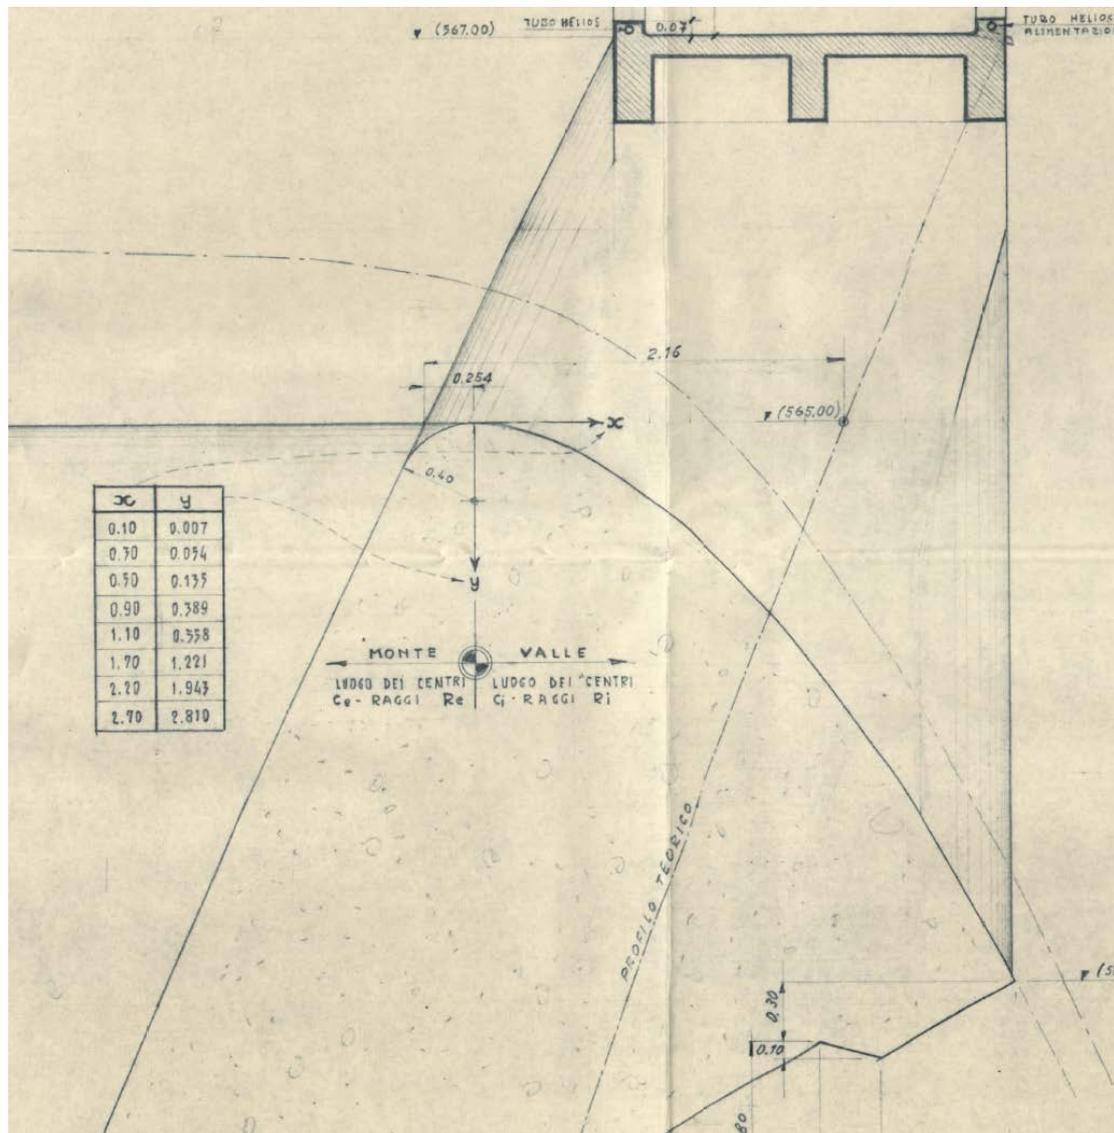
estratto dalla tavola n.21 allegata al collaudo – sezione del ciglio sfiorante.
